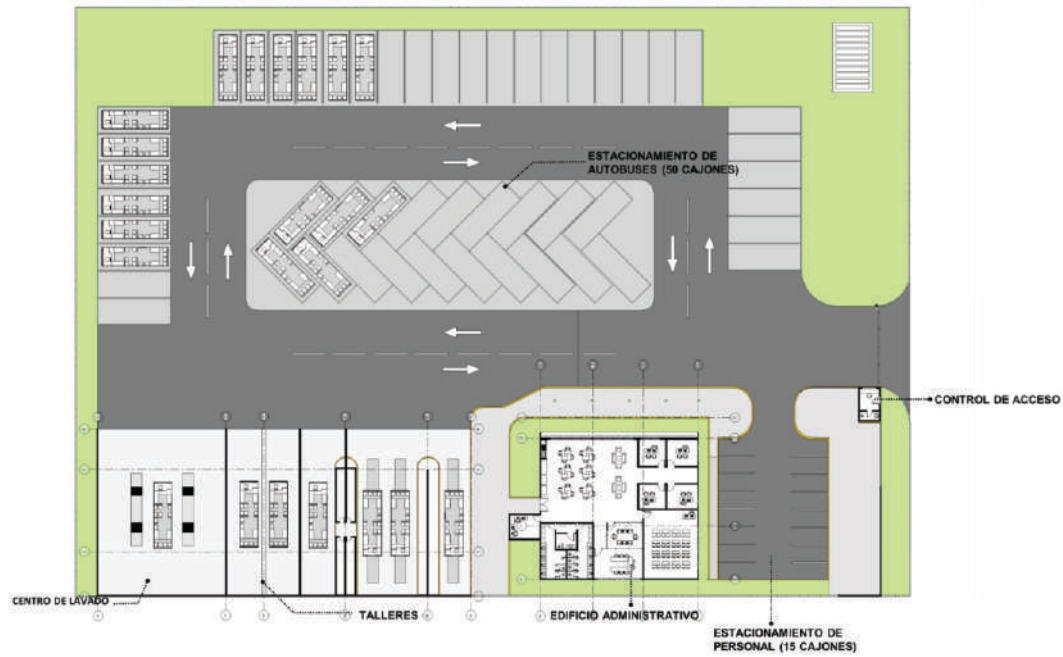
Planta nivel 1 - Patio-Parqueadero
